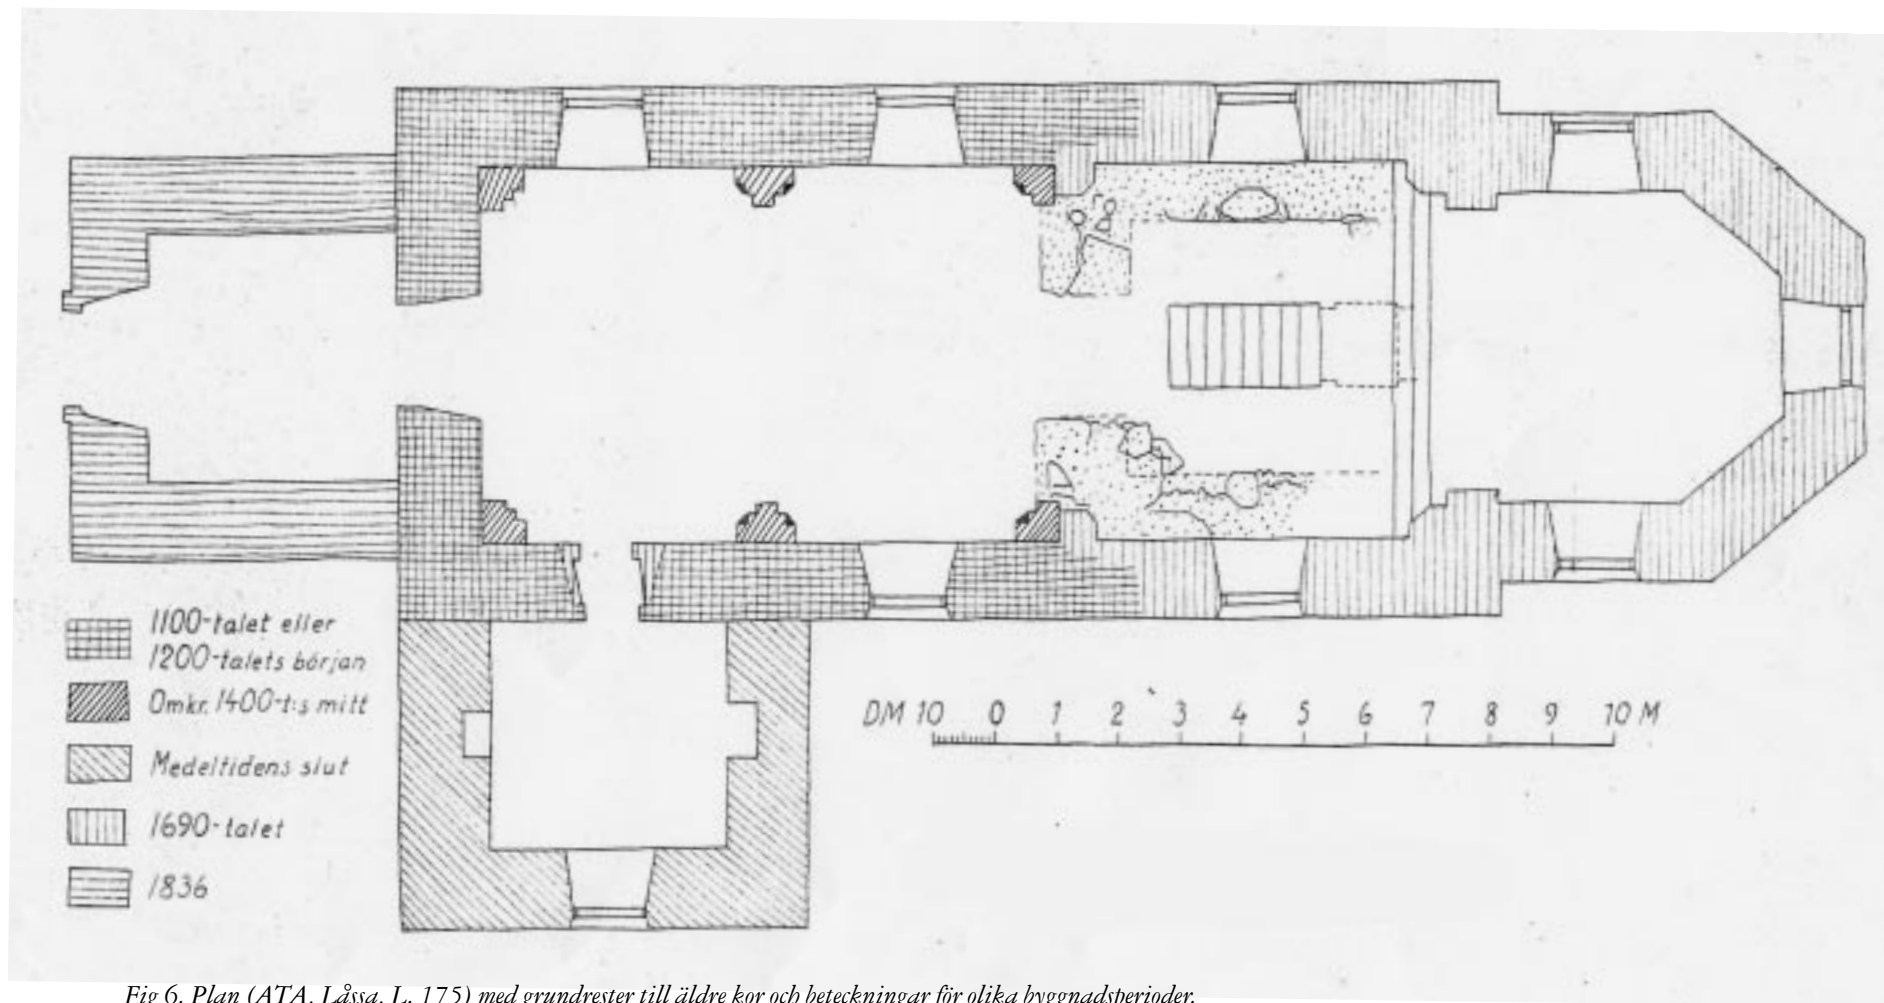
Plan (ATA, Låssa, L. 175) med grundrester till äldre kor och beteckningar för olika byggnadsperioder.
